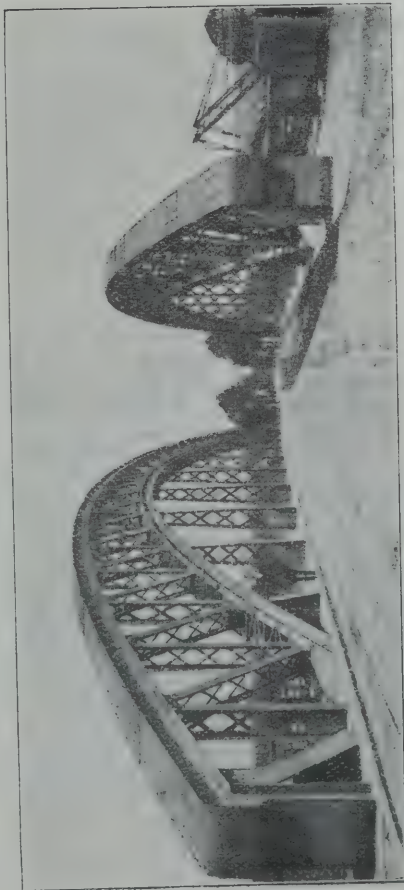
Straßenbrücke für Hauptstraßen (Hauptträger Fachwerkbogen mit Zugband)
